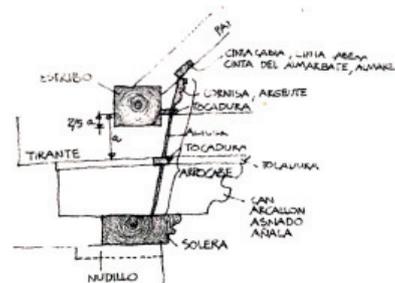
Construcción del estribo según manuales de la carpintería de armar [8]
